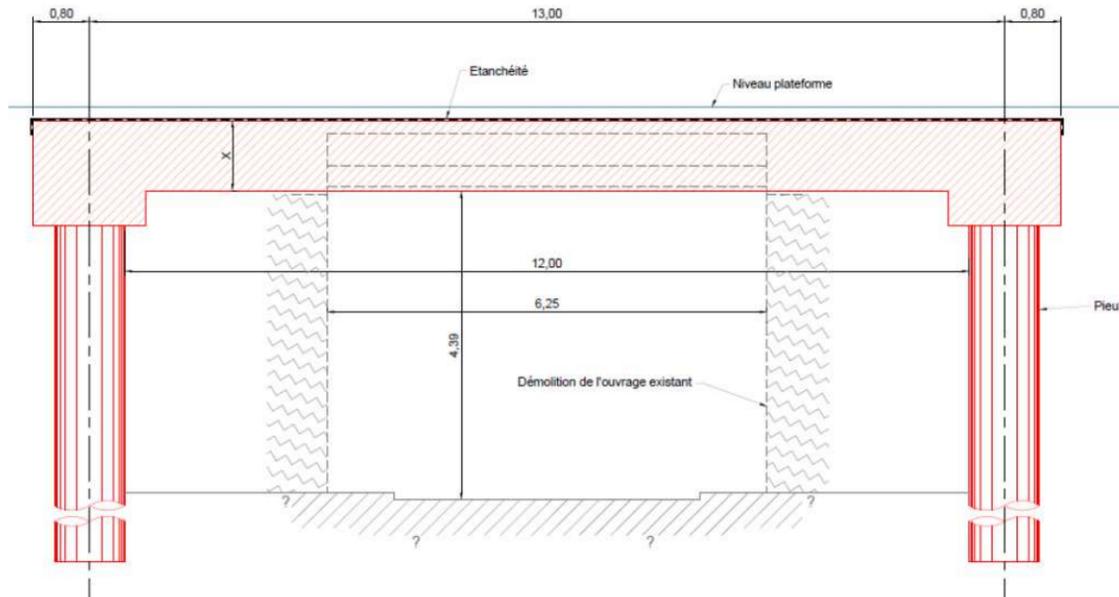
Coupe en travers de l'ouvrage proposé pour le franchissement du Jarret
